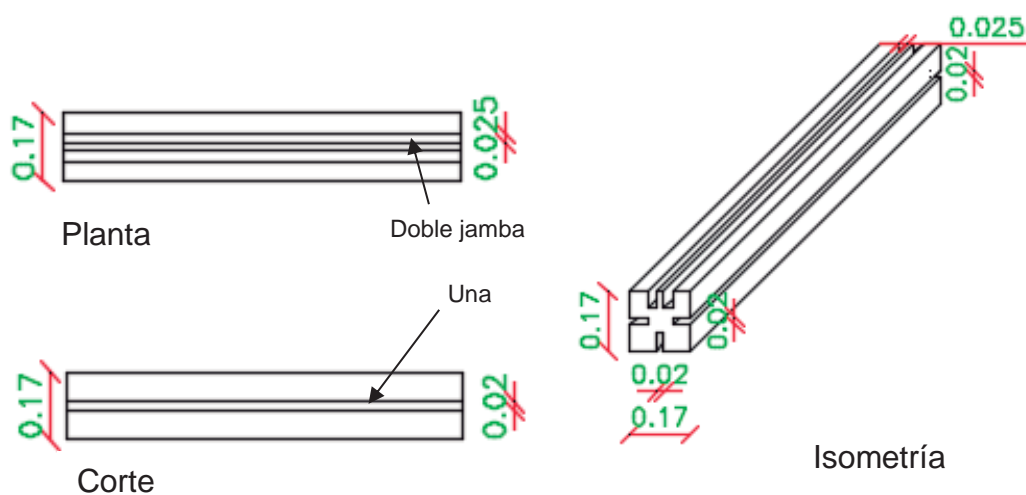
Bloques plásticos reciclado tipo universal - AutoCAD, 2018
